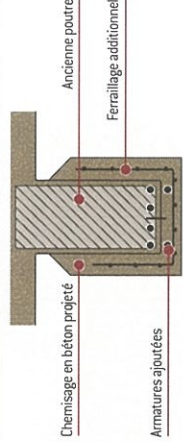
Exemple de renforcement d'une poutre par béton projeté (coupe transversale)
